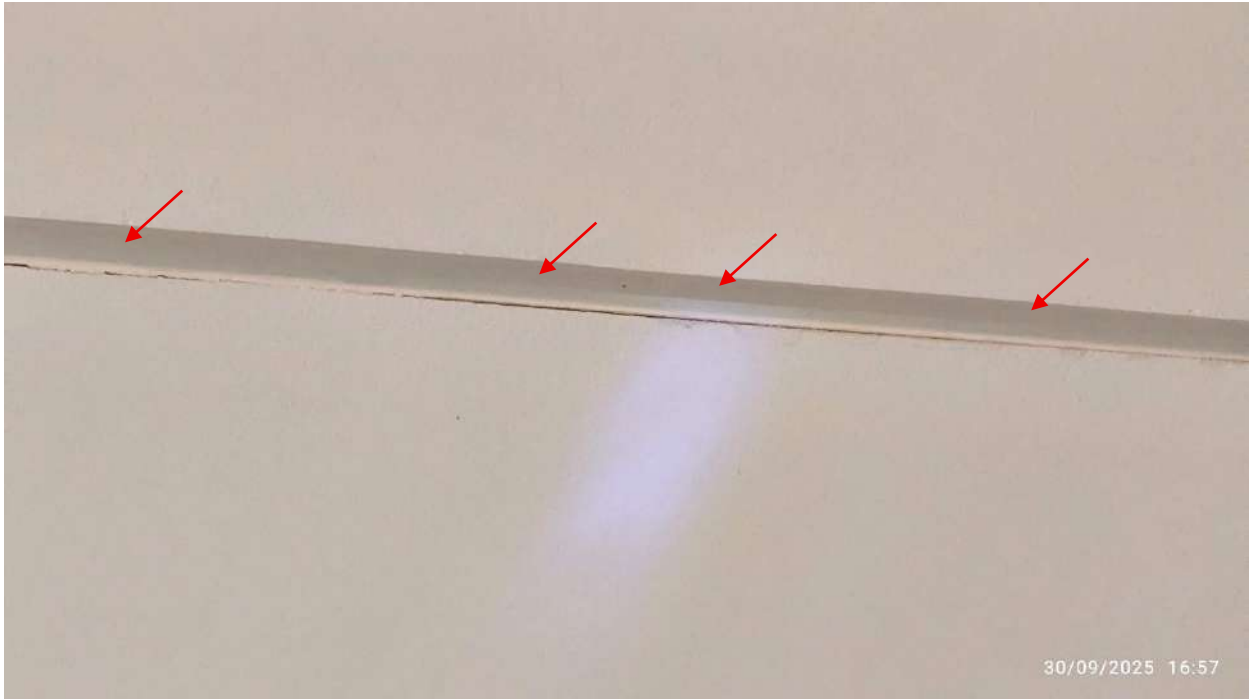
> Detalhe para os indícios de infiltração de água no forro.
